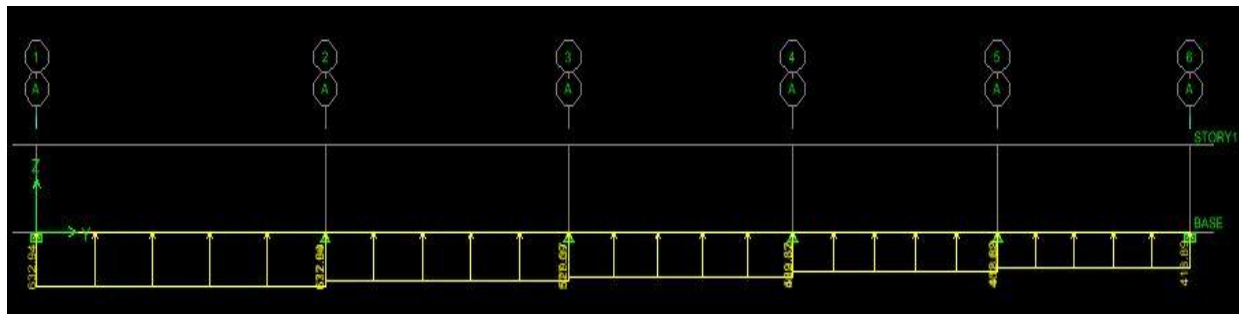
Schéma statique de la nervure ELU (sens transversal)
